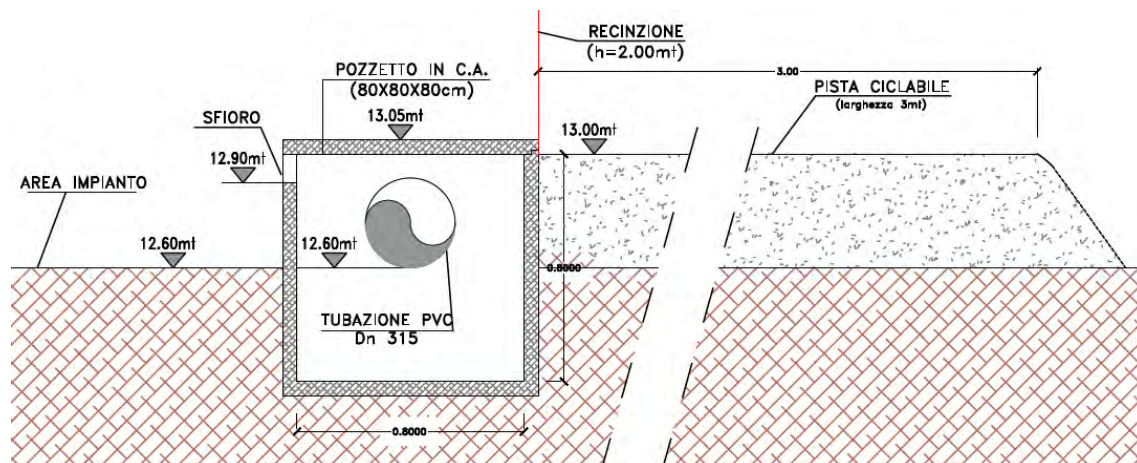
Sezione B-B' pozzetto vasca di laminazione (stralcio elab. FV-SAG-PD-T14-0)
